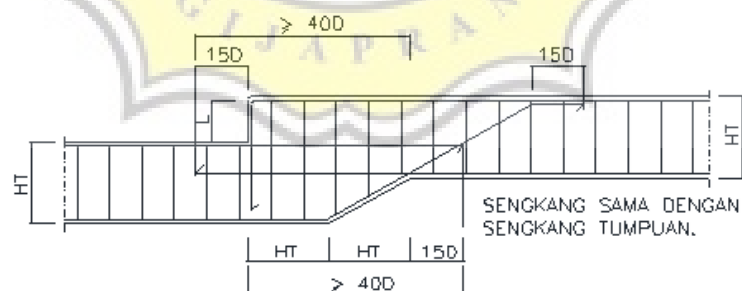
Detail Tulangan dan Sambungan Lewatan Balok
